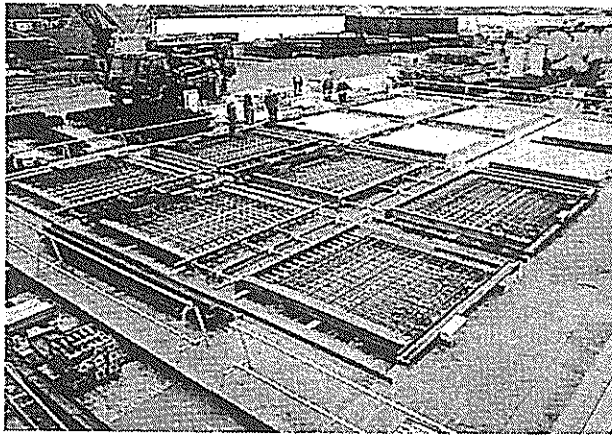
隔壁（プレキャスト部材）製作状況
